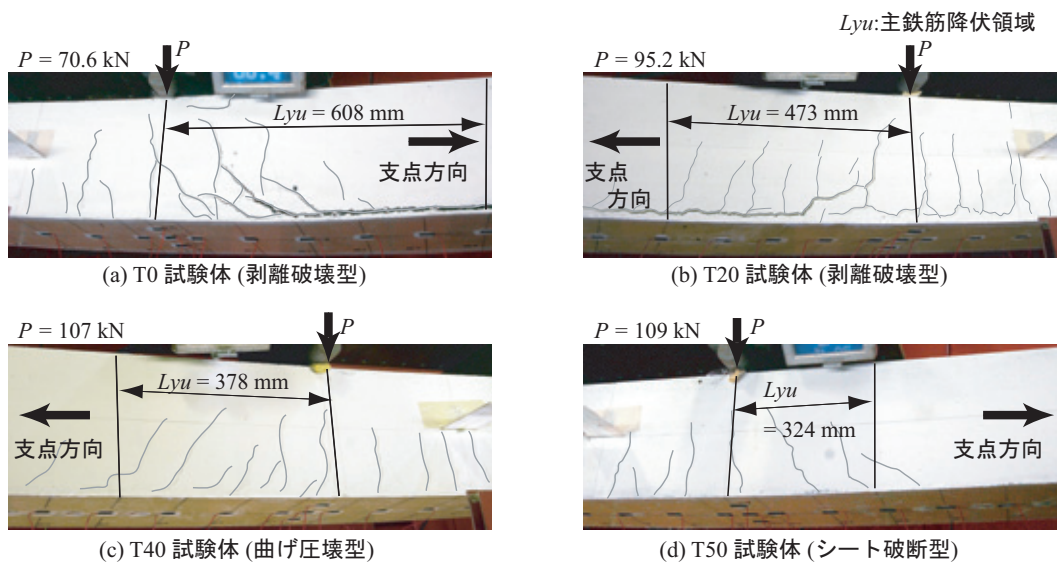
各試験体の終局時近傍におけるひび割れ性状
